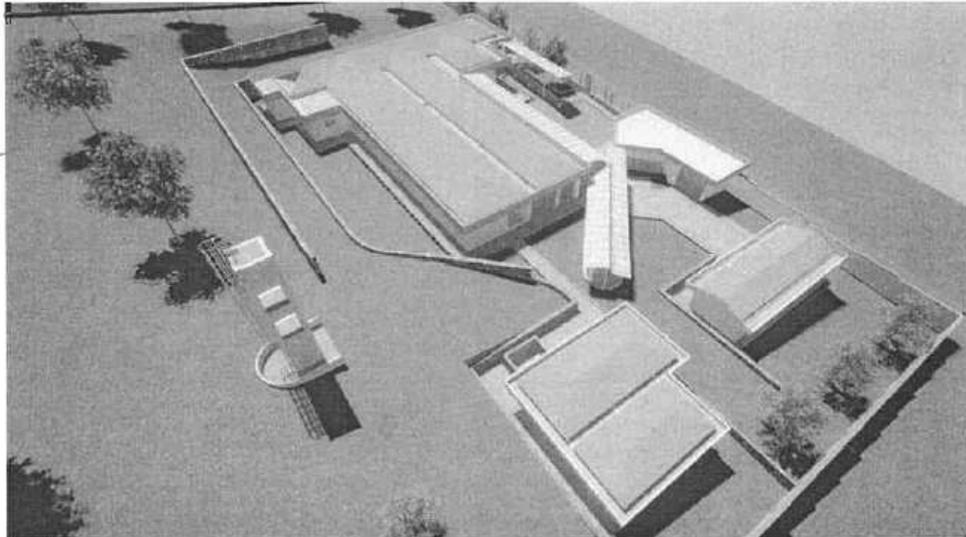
VISTA PANORAMICA POSTERIOR DEL PUESTO DE SALUD DE
